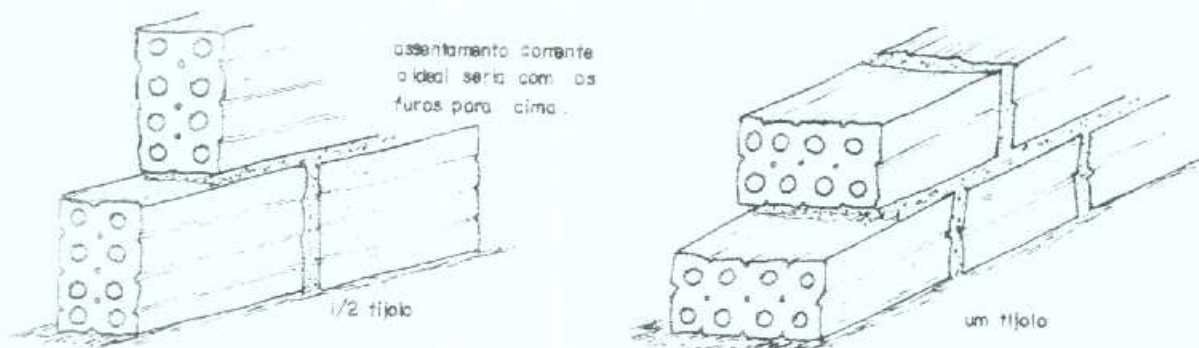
Execução de alvenaria utilizando tijolos furados.
